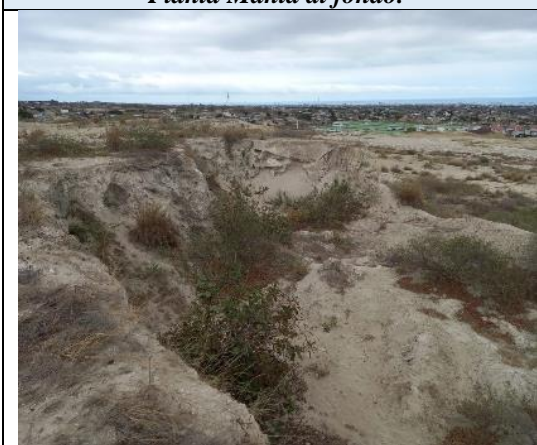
Tramo 4 en tierra Avda. Francisco Robles acceso a futura Planta Manta.
